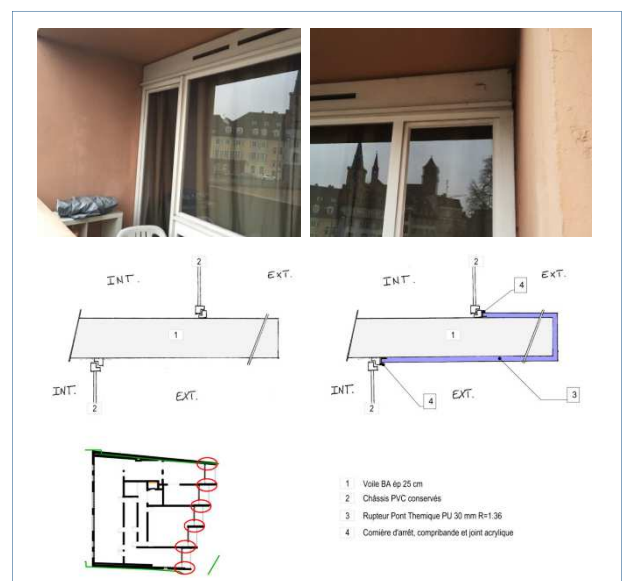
traitement des balcons et des murs de refend verticaux en façade (source m-associés architectes)
